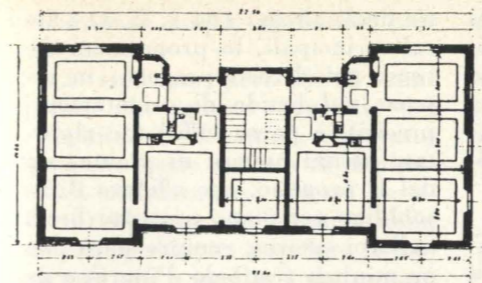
Progetto 1° classificato: pianta - tipo di un edificio con 4 alloggi per piano.
